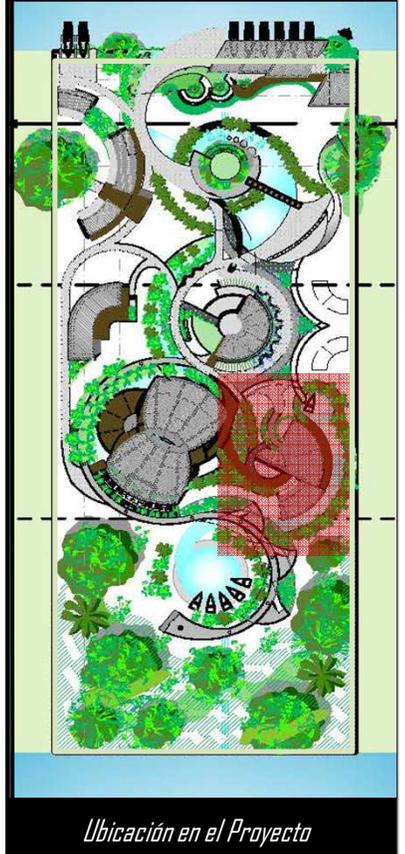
Planta de distribución arquitectónica Espacio Recreativo
